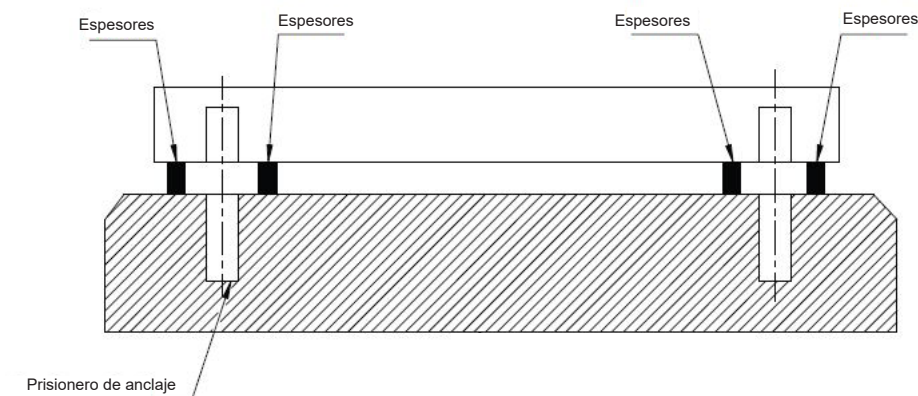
Aplicación de cimientos de hormigón, cuchilla y anclaje
